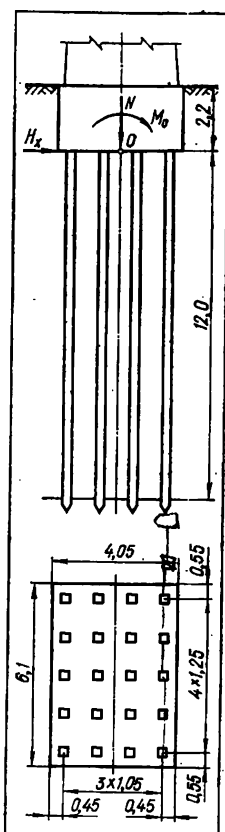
Схема фундамента с плитой, расположенной в грунте (низкий ростверк), и вертикальными сваями сечением 35×35 см.
